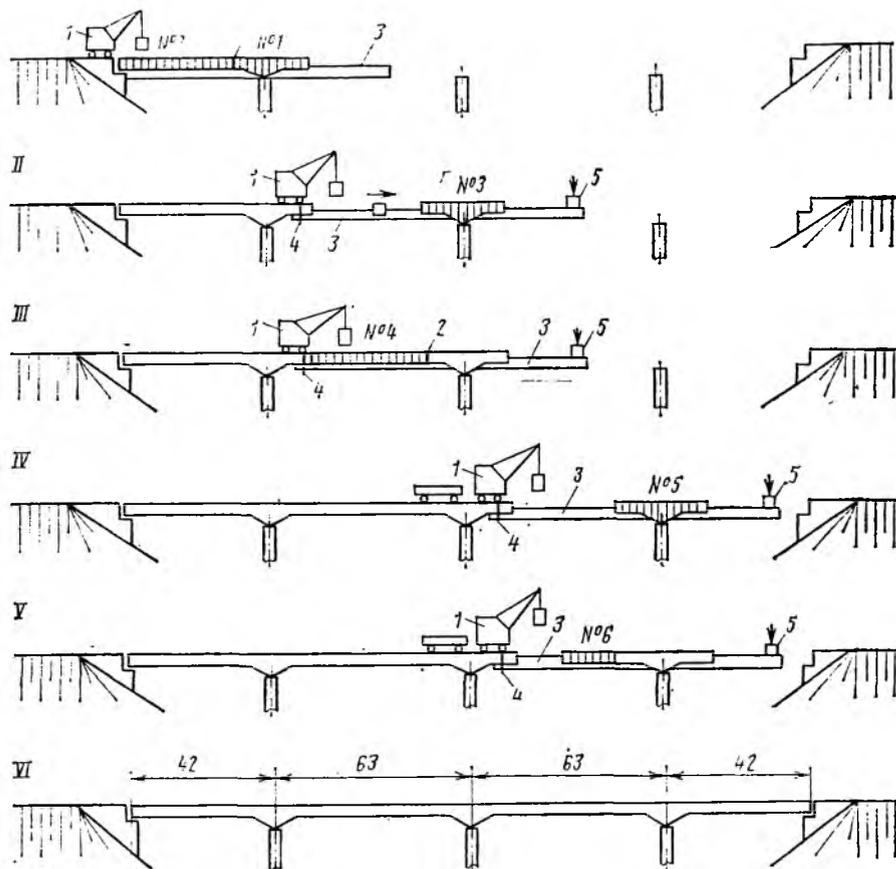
Последовательность (I—VI) монтажа плитно-ребристых неразрезных пролетных строений со схемой $42+2 \times 63+42$ м на чермещаемых подмостях: № 1—№ 6—последовательно собираемые секции (участки); 1—монтажный кран; 2—мополитные стыки между собранными секциями; 3—перемещаемые подмости; 4—подхват; 5—противовес
